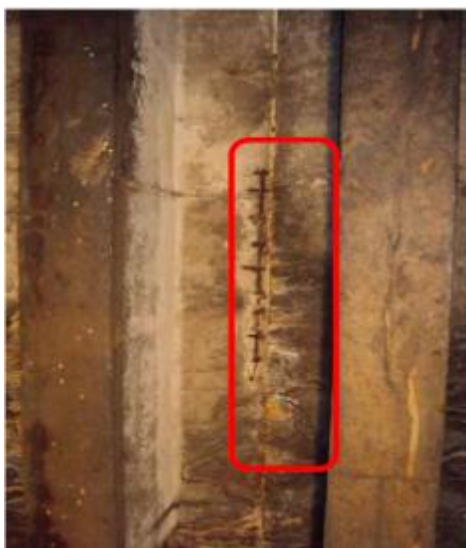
Face inferior da mesa superior da viga VSE com concreto disgregado e armadura exposta e oxidada.
